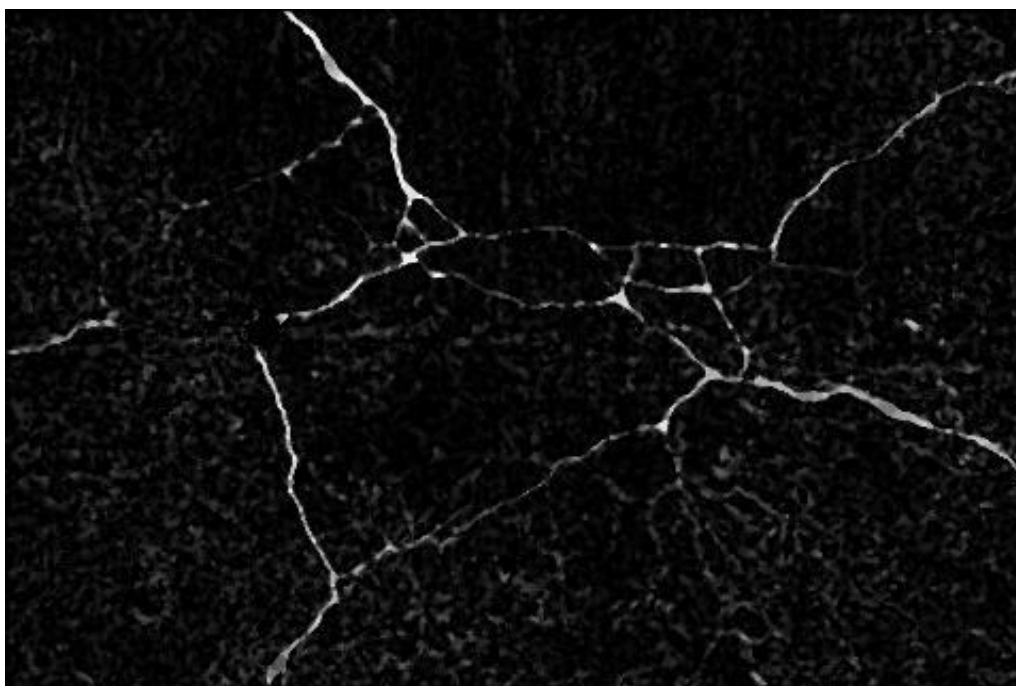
Exemplo de Aplicação 2 (Fissuras) – Imagem Processada.
